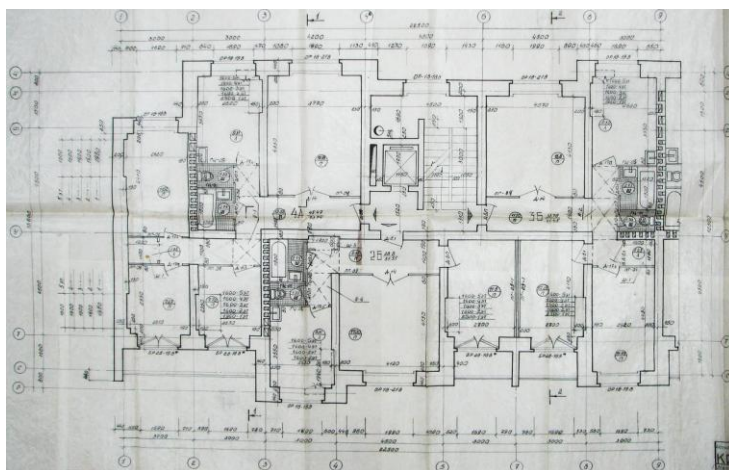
План в осях 1-9 жилого дома по ул. Урицкого, д. 98.
